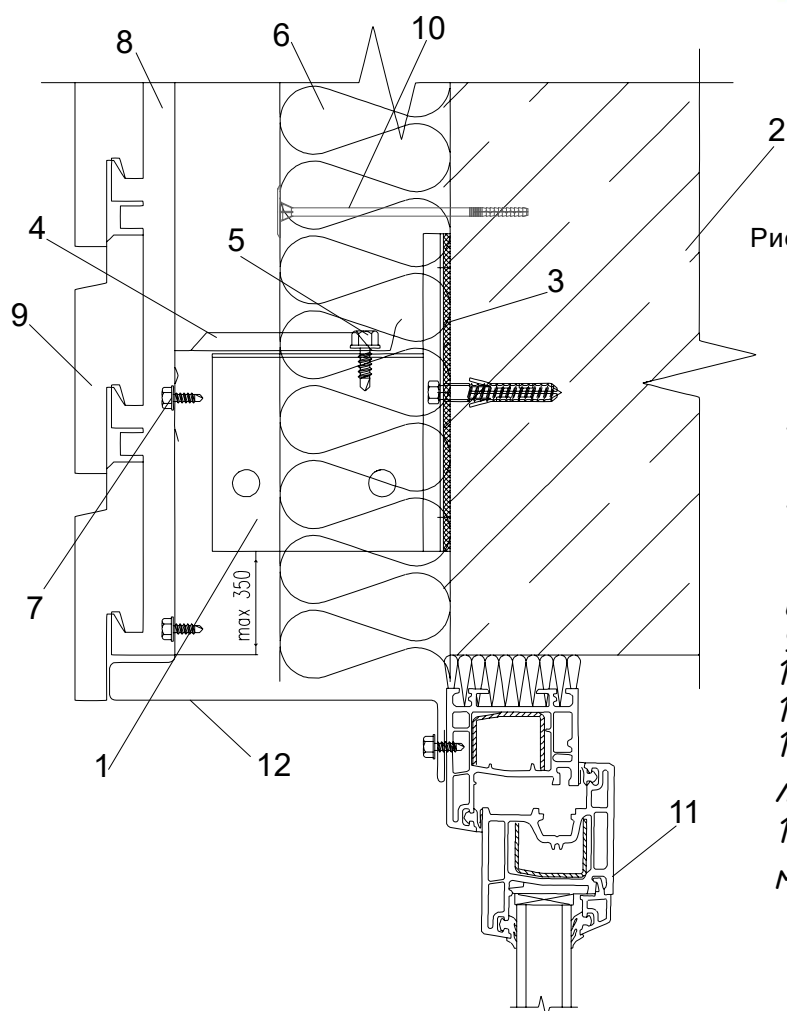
а. Конструкция вертикального откоса из металла. Горизонтальный разрез.
